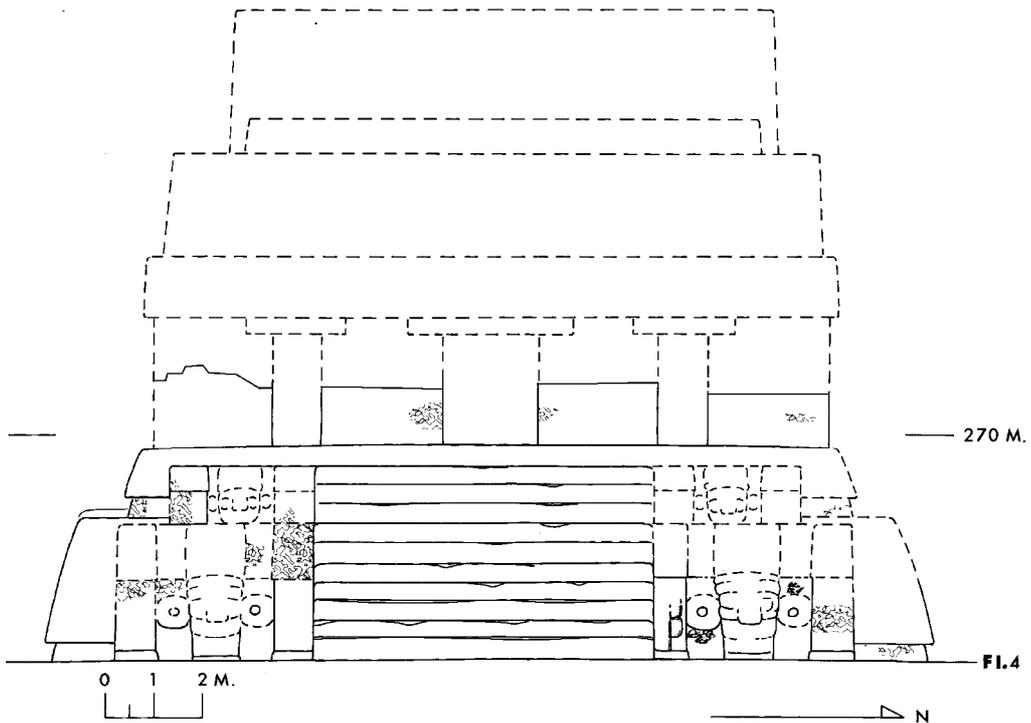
Estr. 5D-23 Vista general de fachada E. Sus daños son menores que en las fachadas del Sur y Oeste. Vemos desgastes por el paso de turistas sobre las gradas. (Modificado de Tikal Report No.14)
